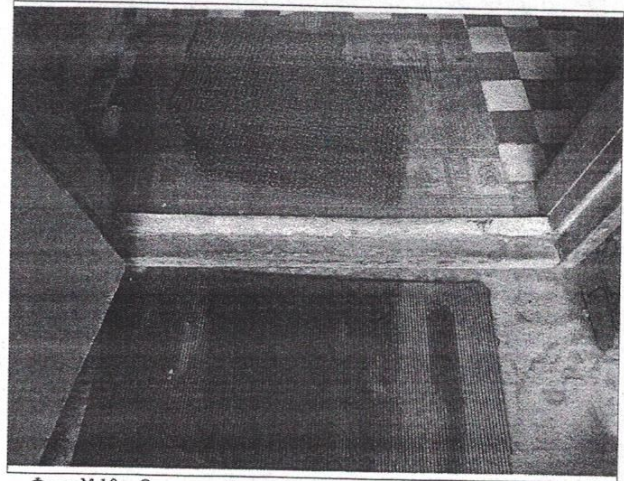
Отдельный вход в группу расположенную на первом этаже. Наружная входная дверь
